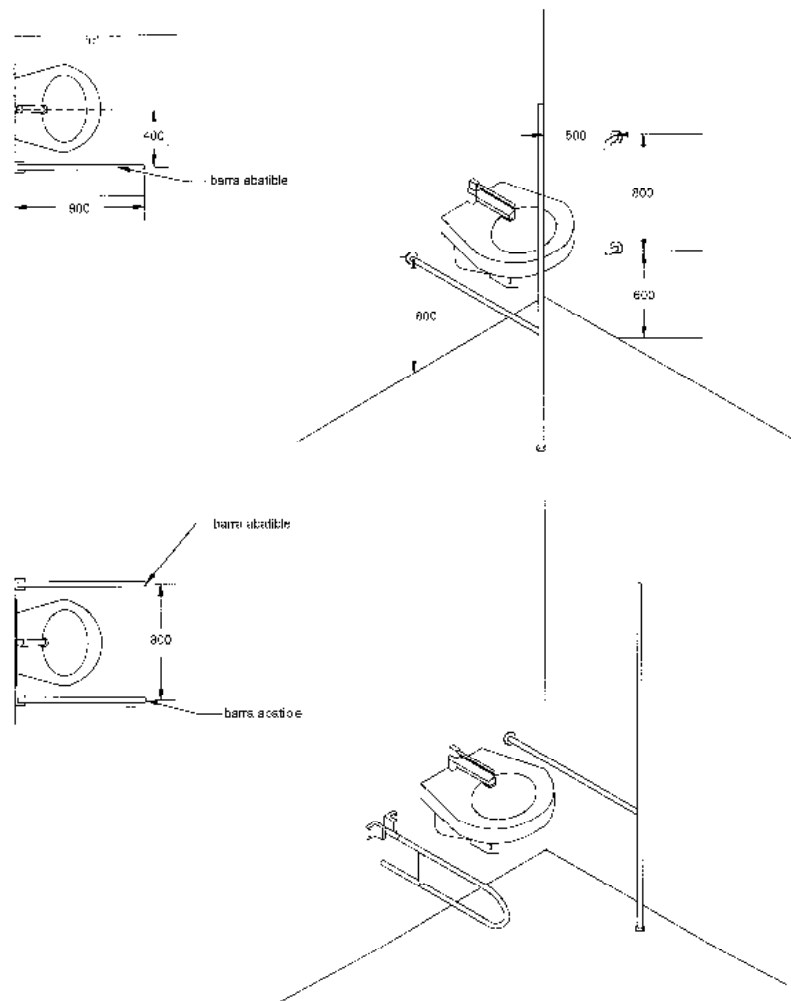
Barras de apoyo. Forma y disposición (Dimensiones en mm)
